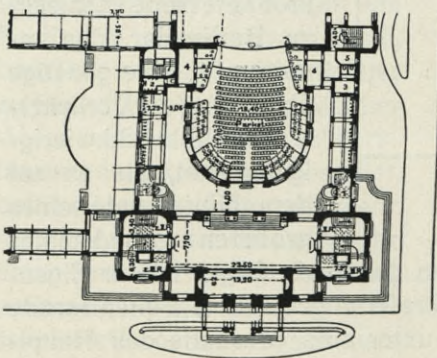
Stadttheater zu Frankfurt a. M. Grundriß des Zuschauerhauses.
